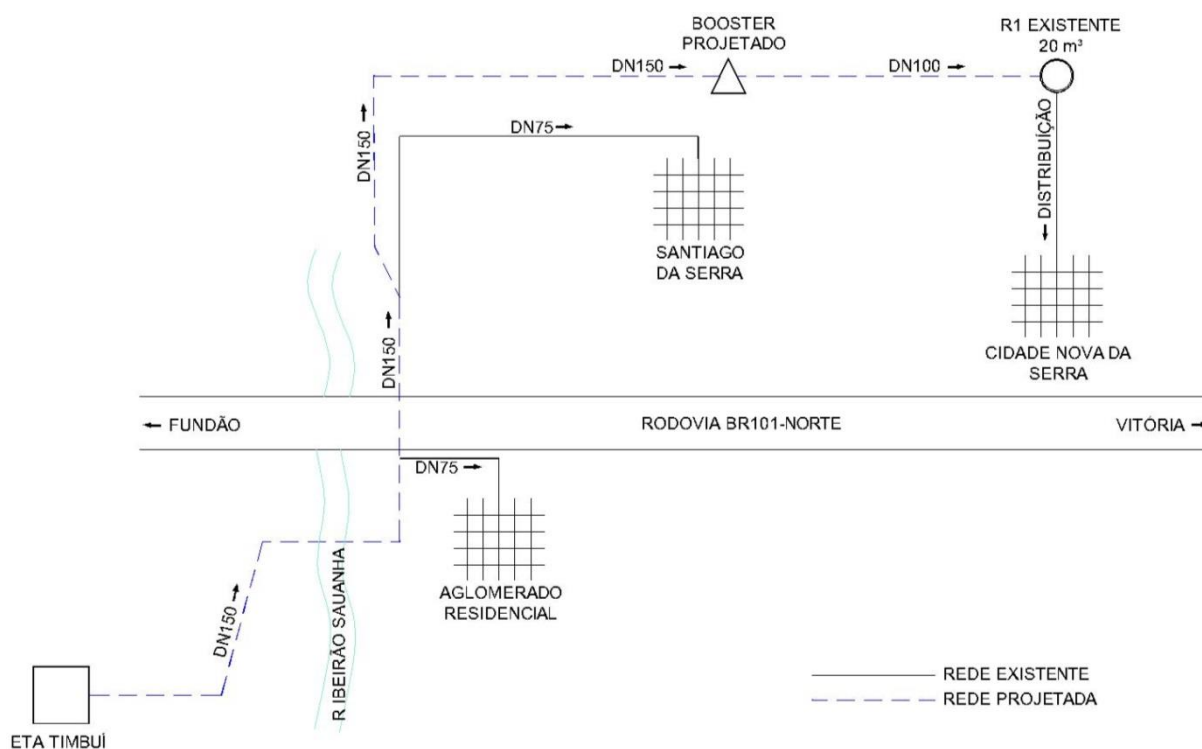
Esquema geral em planta da proposição do Cenário 2 (Definitivo).
